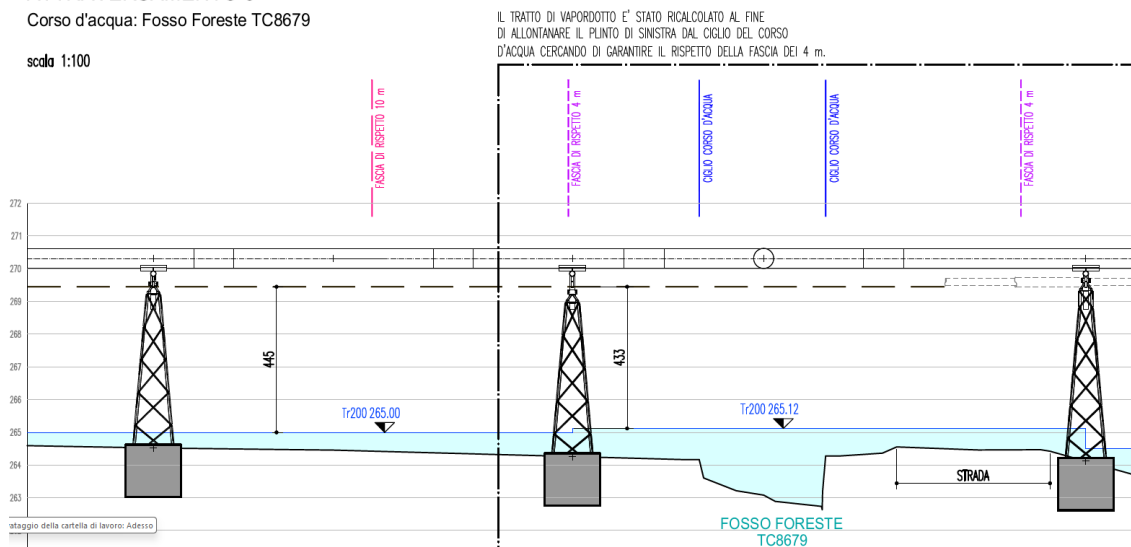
Attraversamento A5 del Fosso Foreste (TC8679)
